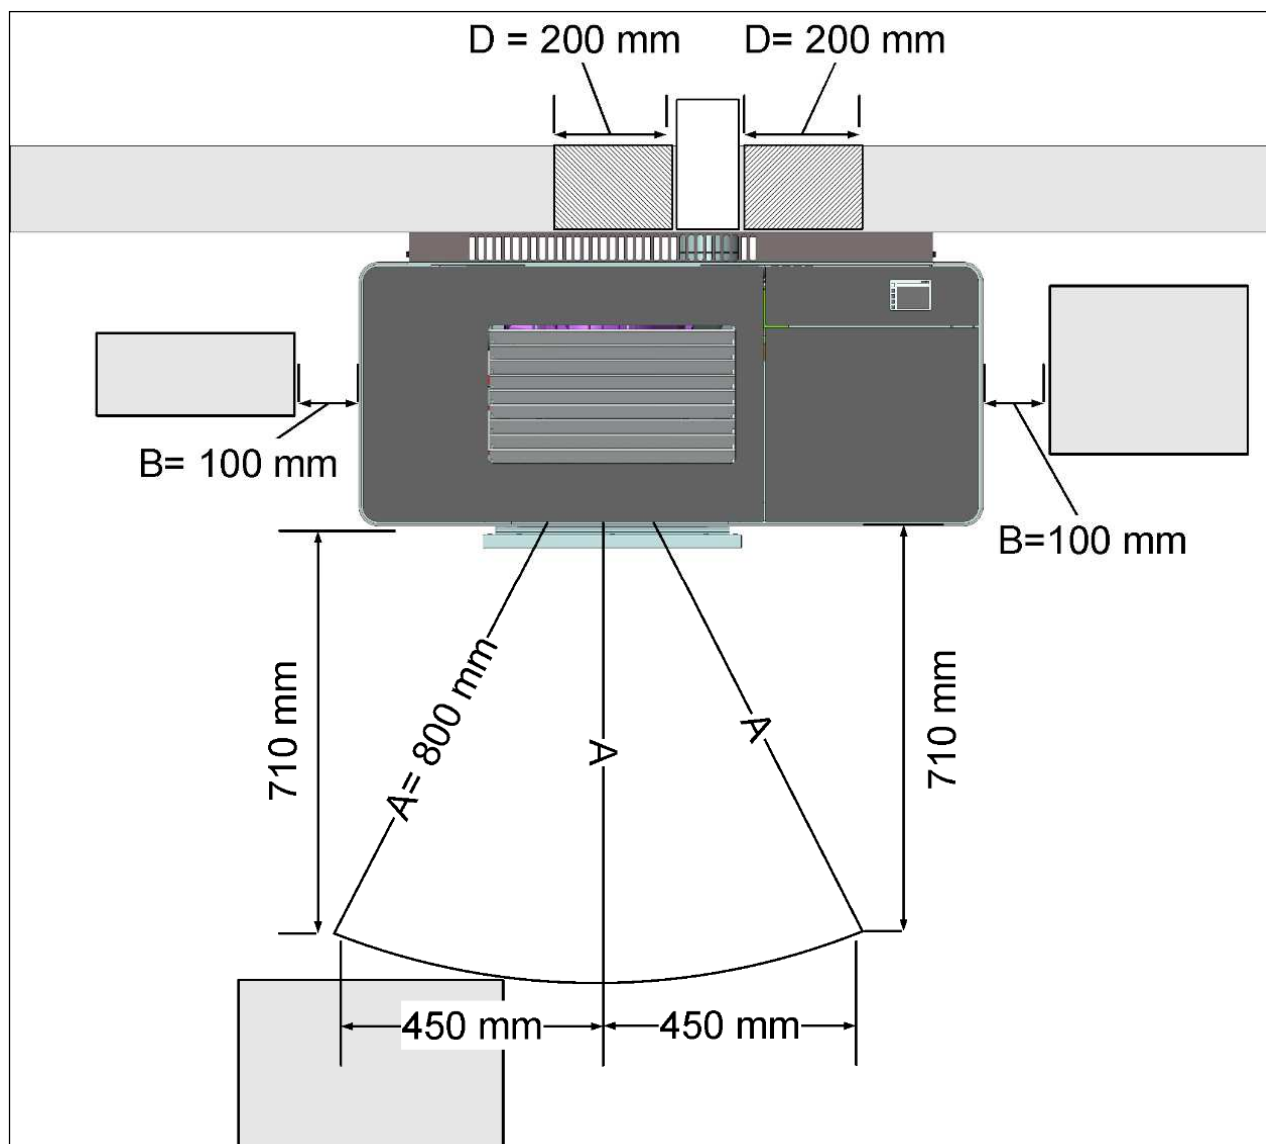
Brandschutzabstände horizontaler Anschluss ixbase
